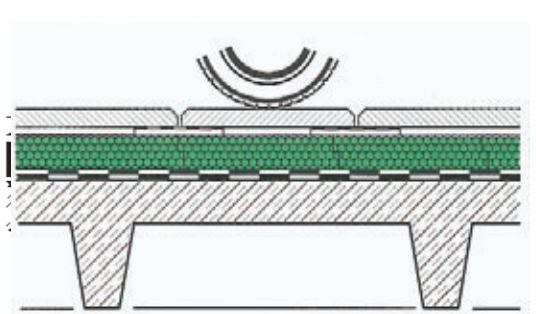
Schichtaufbau des Parkdecks mit aufgestellten kleinformatigen Betonplatten, P 2.
